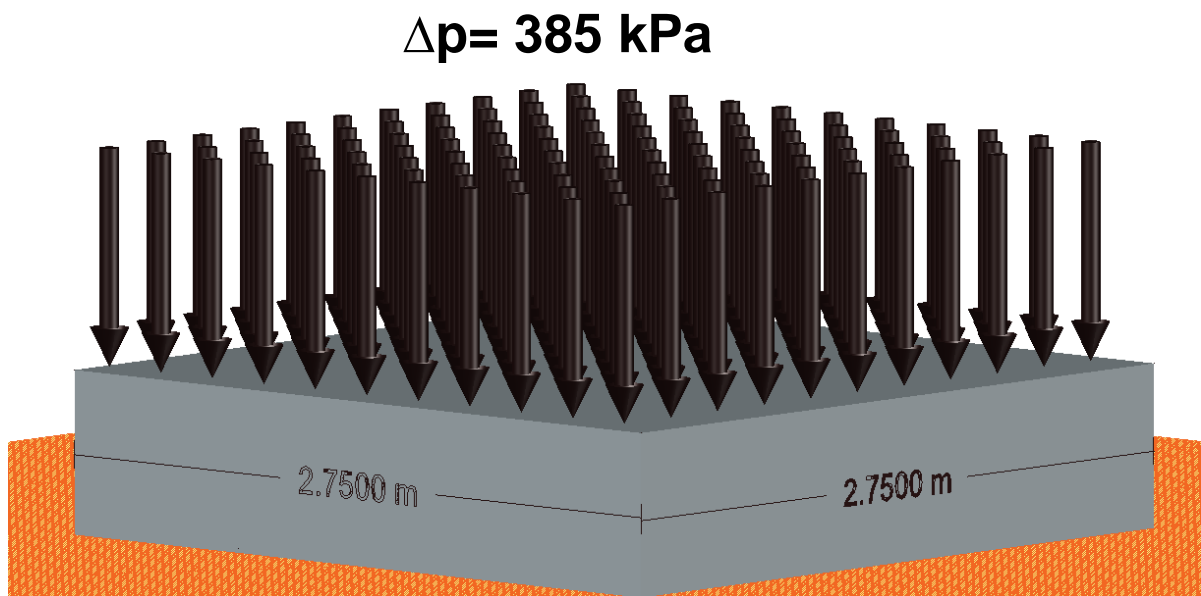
Estado de cargas actuante sobre la zapata de estudio.
